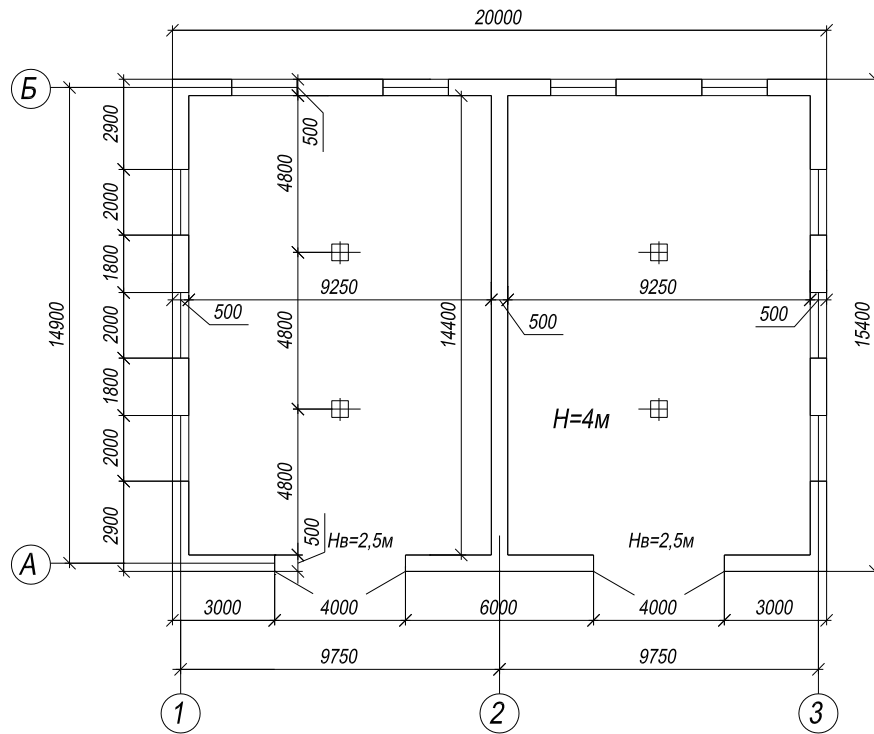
План будівлі для порівняння трудомісткості
